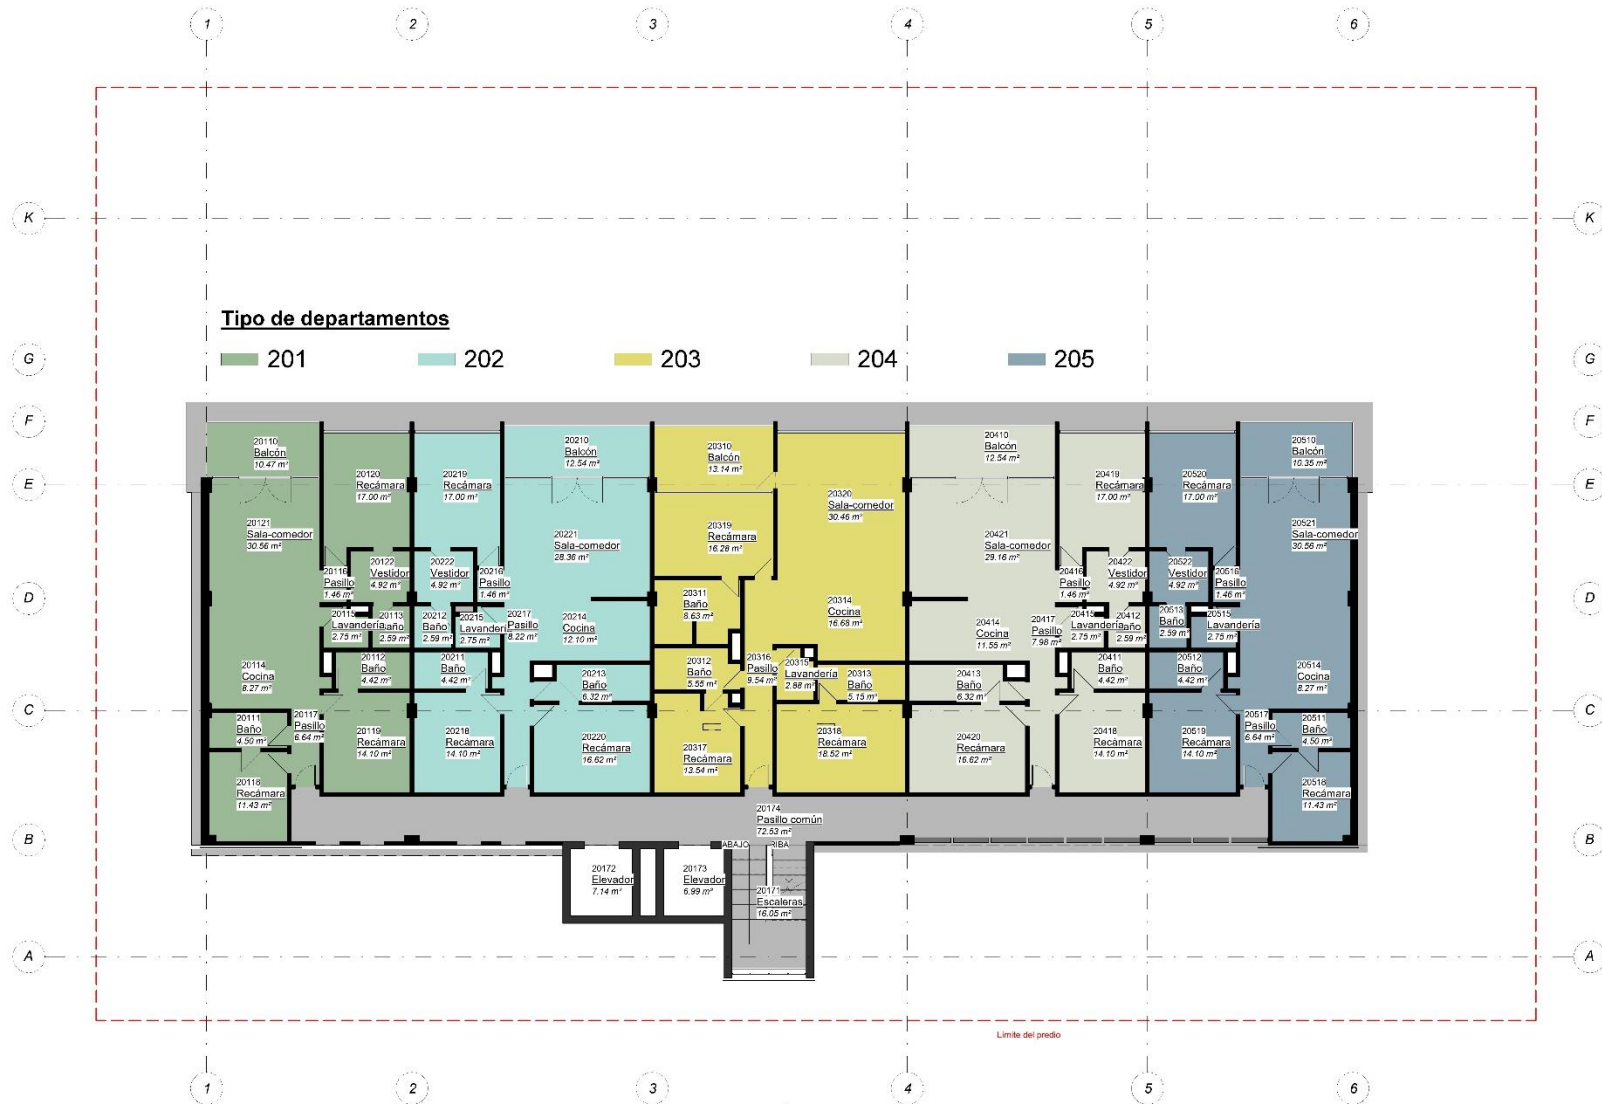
Planta tipo y distribución de departamentos tipo
